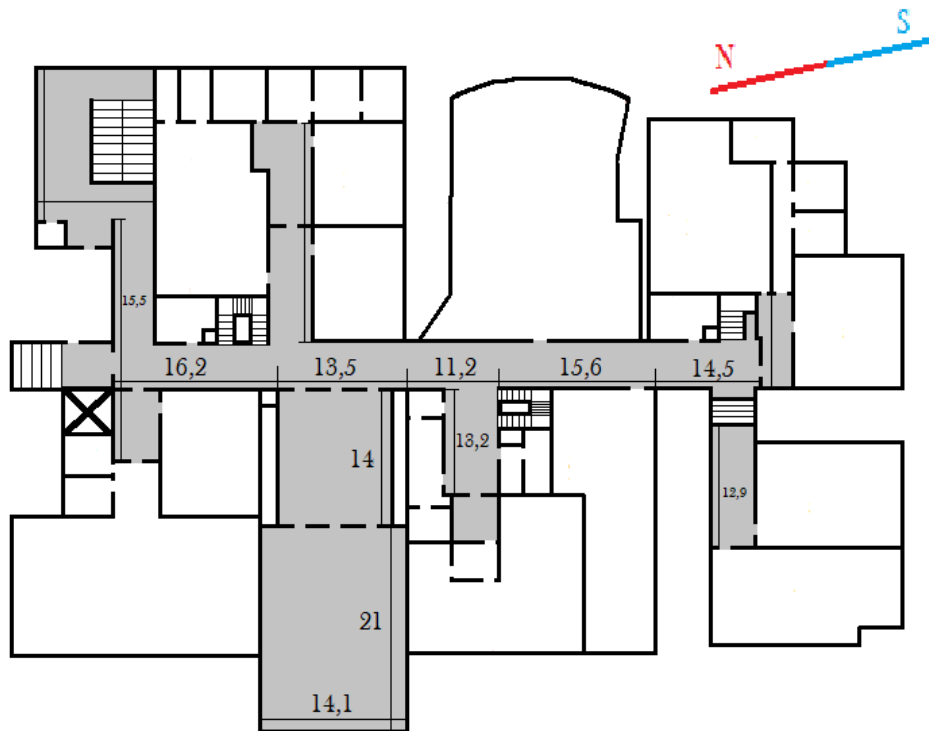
Plano con medidas de la planta baja de la EII sede Fco. Mendizábal.
